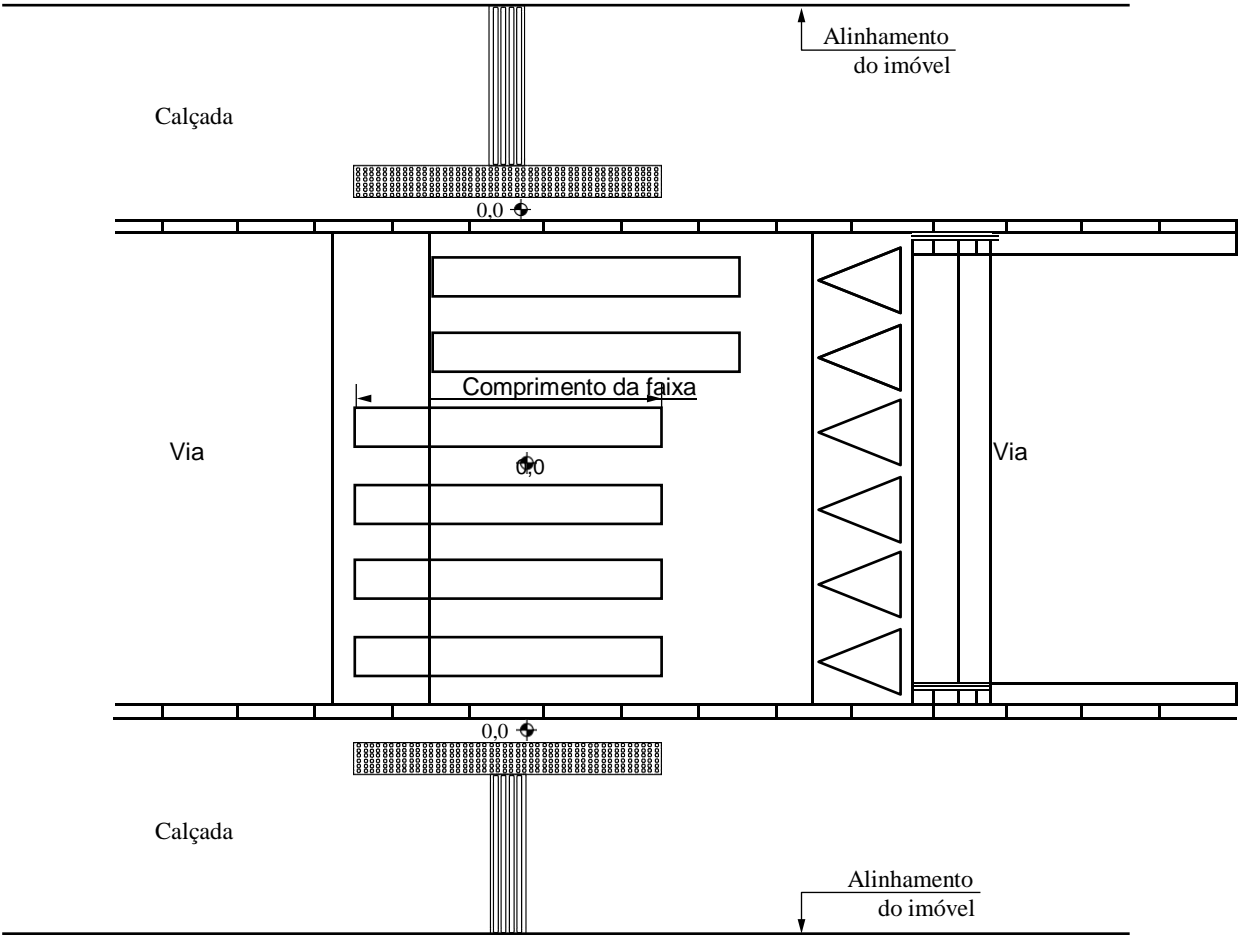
Faixa elevada para travessia – Exemplo – Vista superior
